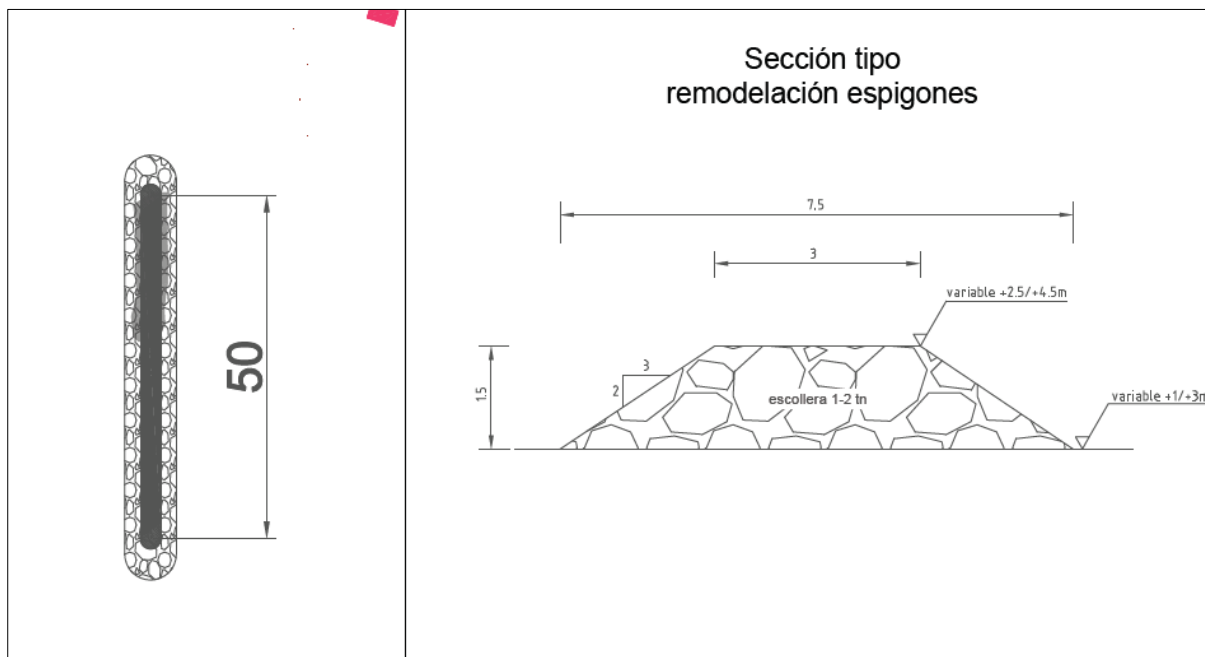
Detalle de la remodelación de los espigones. Planta y perfil tipo.
